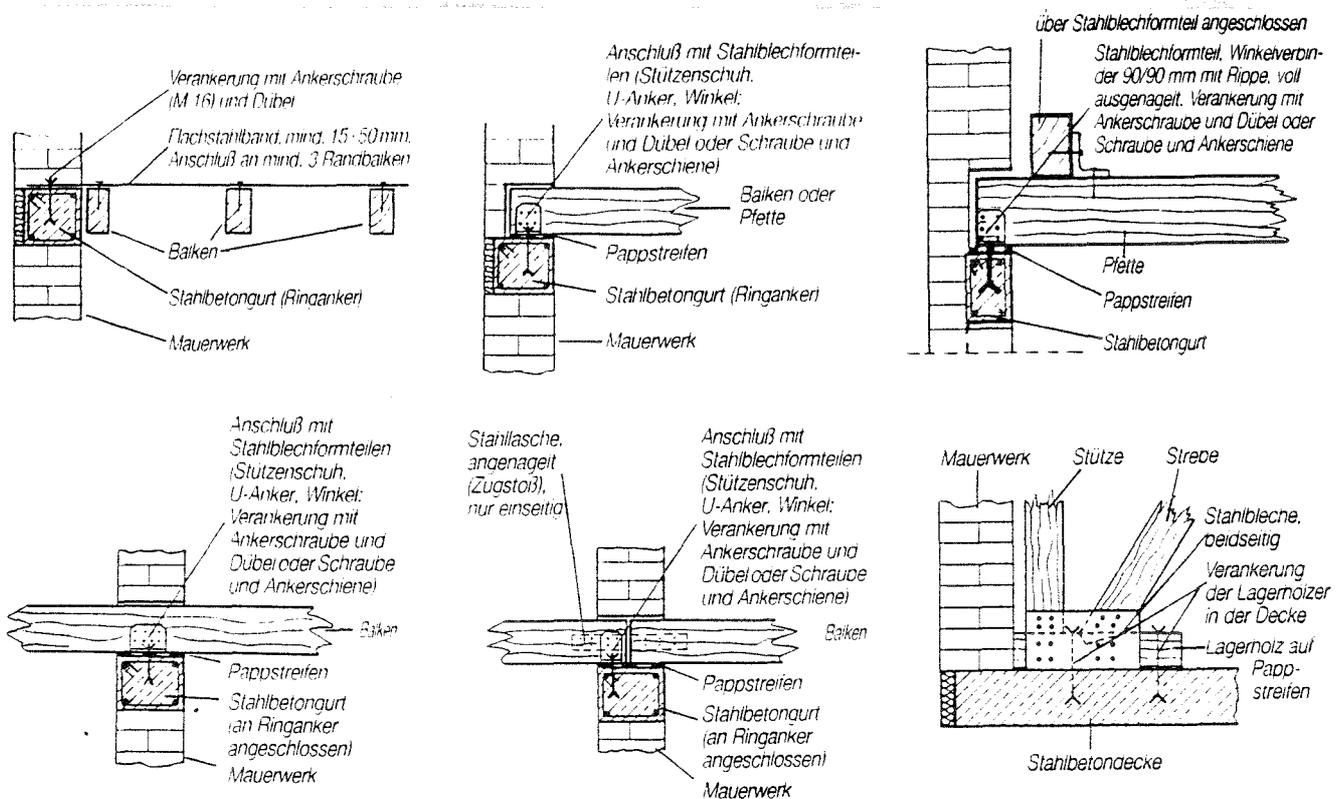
Anschluß von Holzbauteilen an Massivbauteile nach [14]
